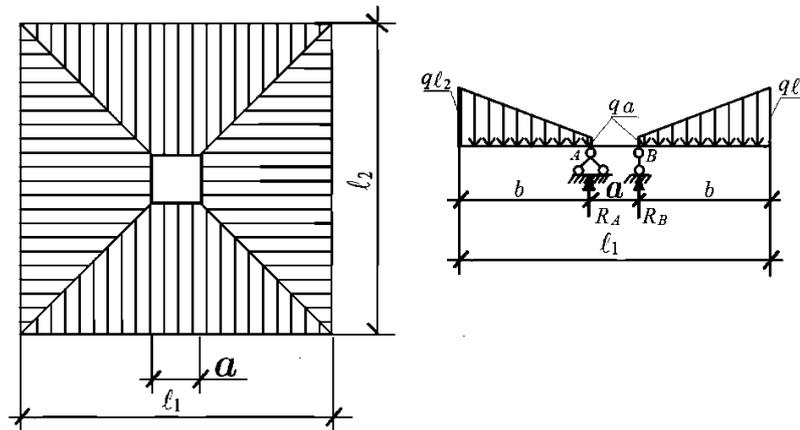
Схема розподілу навантаження для надколонної плити:
